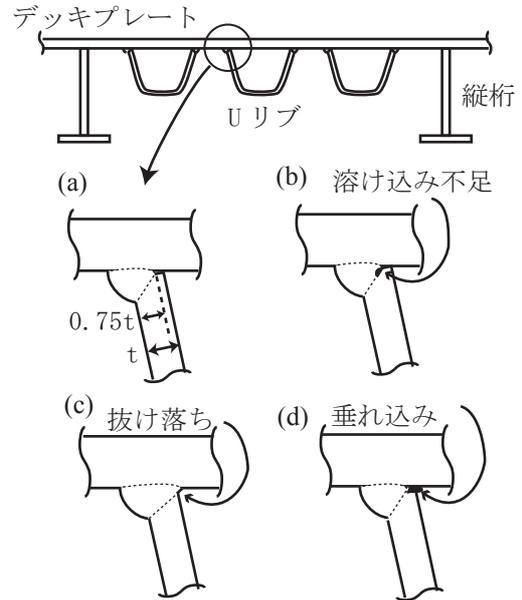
鋼床版縦リブ・デッキプレート溶接部
